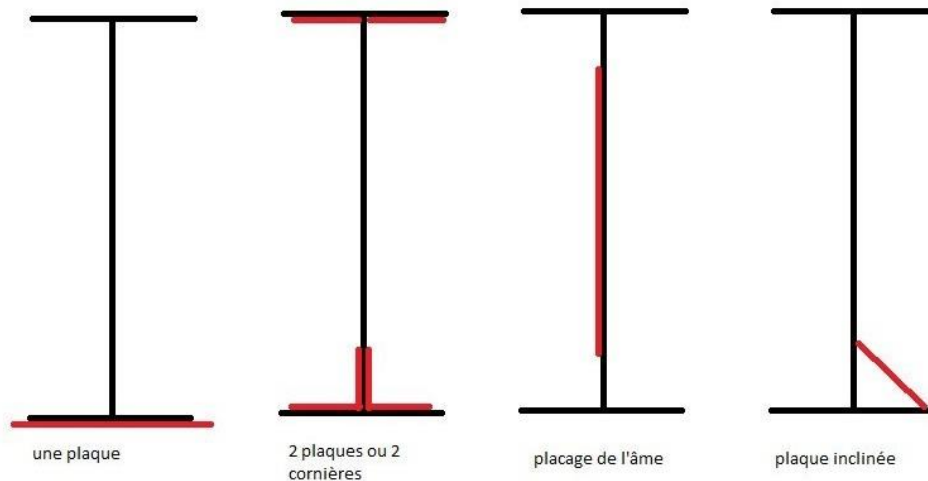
Renforcement par placage d'une poutre en I (GUIDES STRRES, 2010)
